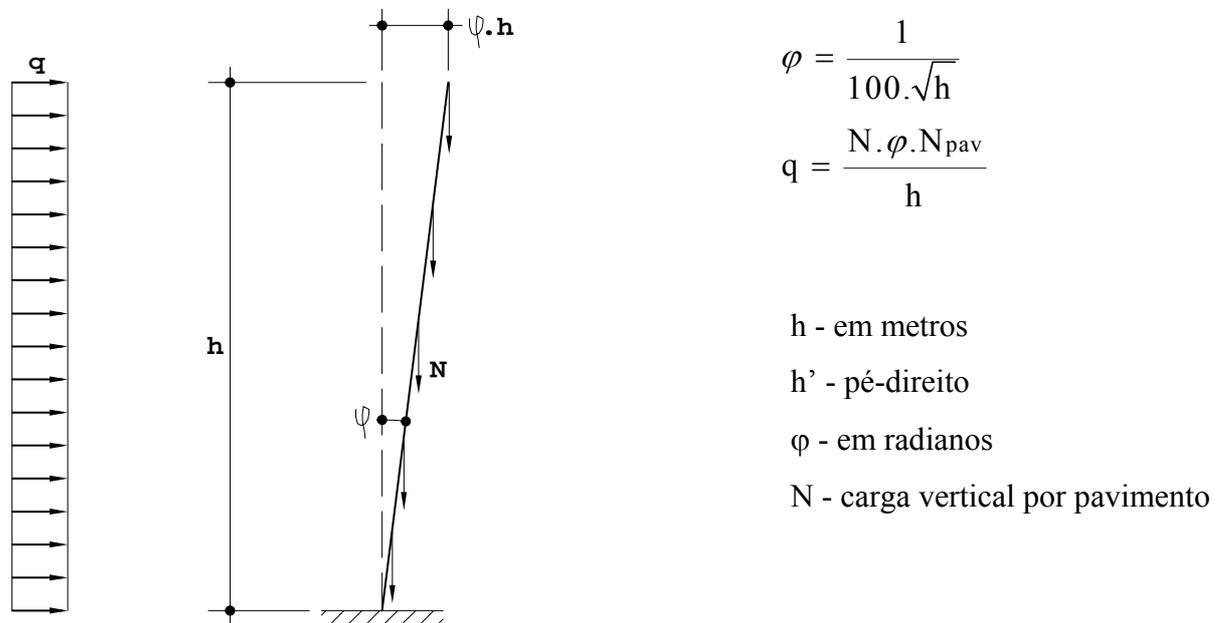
Deslocamento horizontal em paredes de contraventamento.
